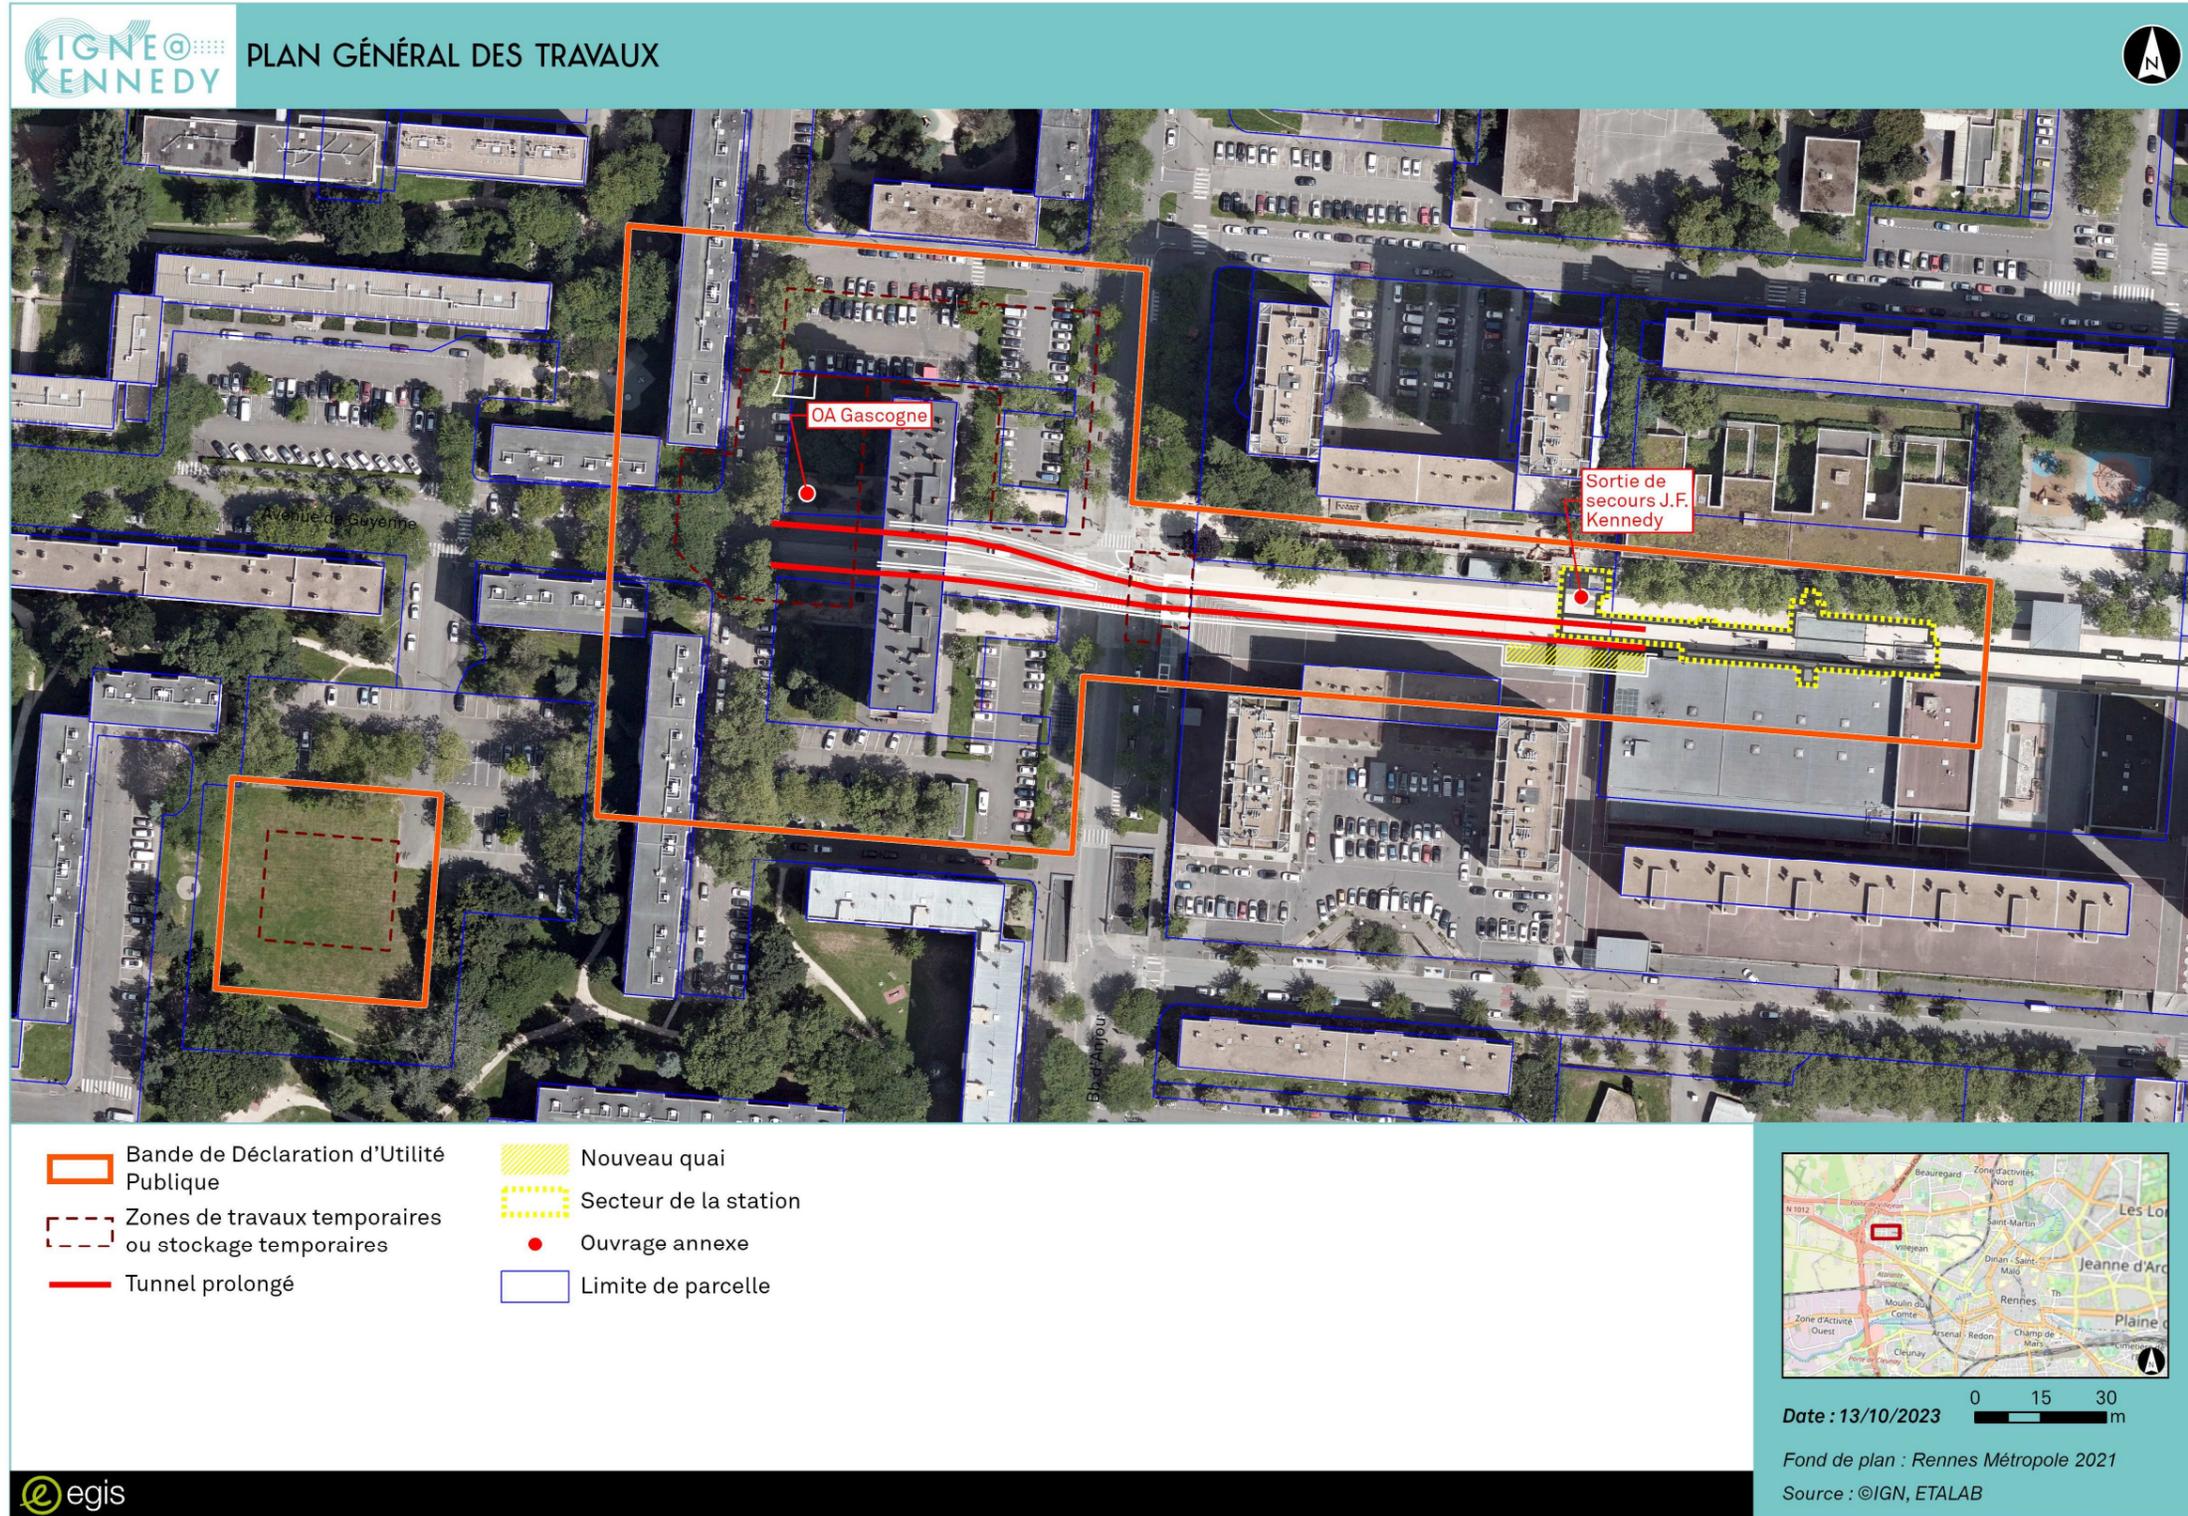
PLAN GÉNÉRAL DES TRAVAUX
